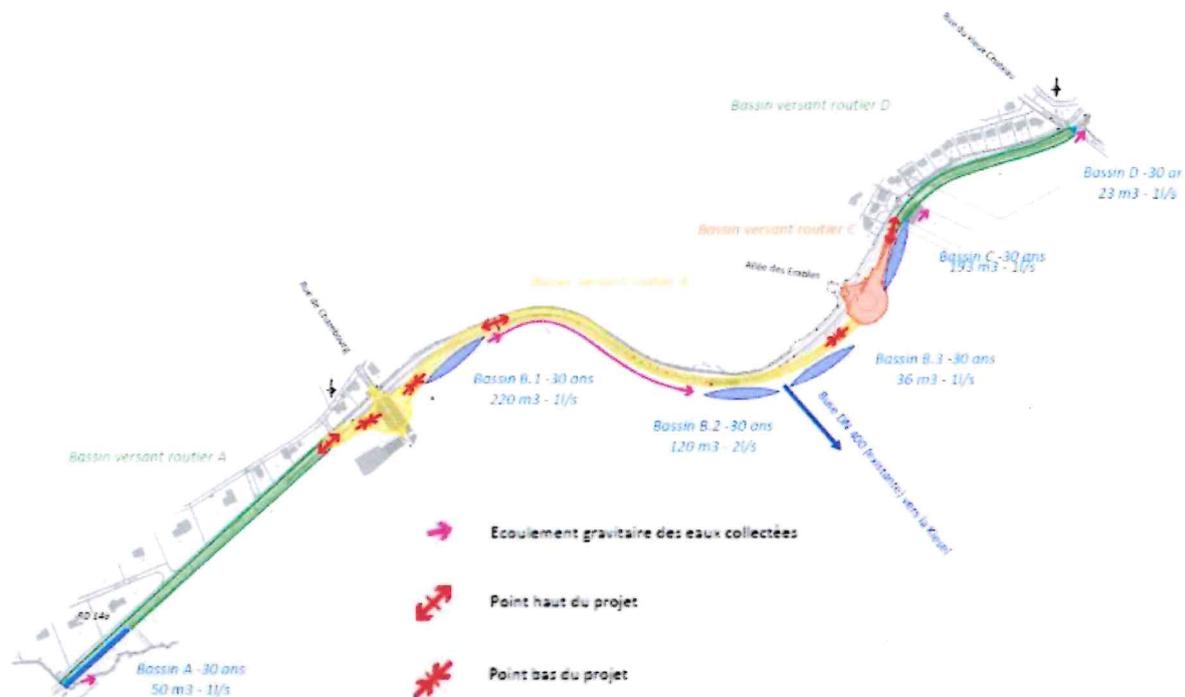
Plan des ouvrages de gestion des eaux pluviales
